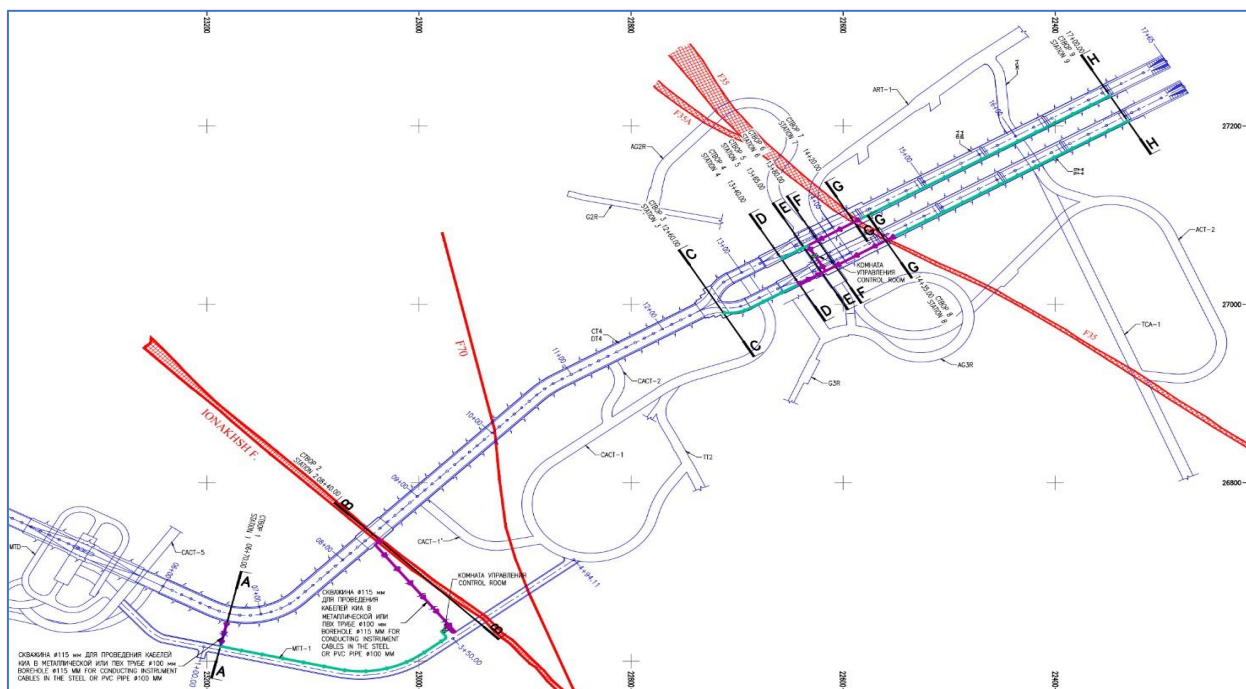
План строительного тоннеля СТ-4 Рогунской ГЭС
